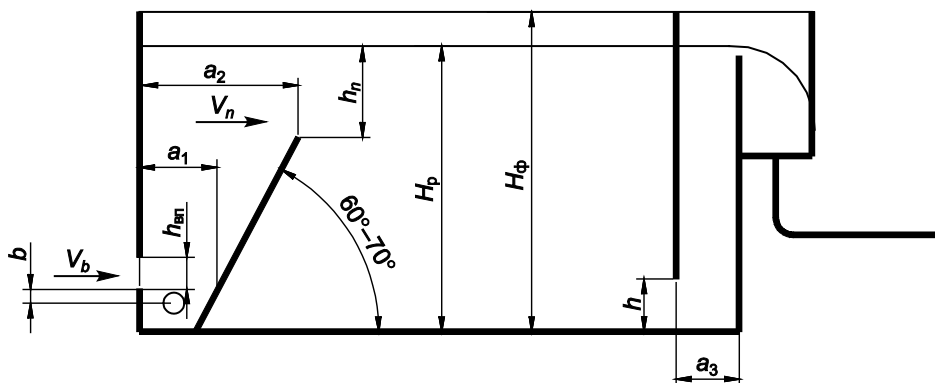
Расчетная схема прямоугольной флотационной камеры
